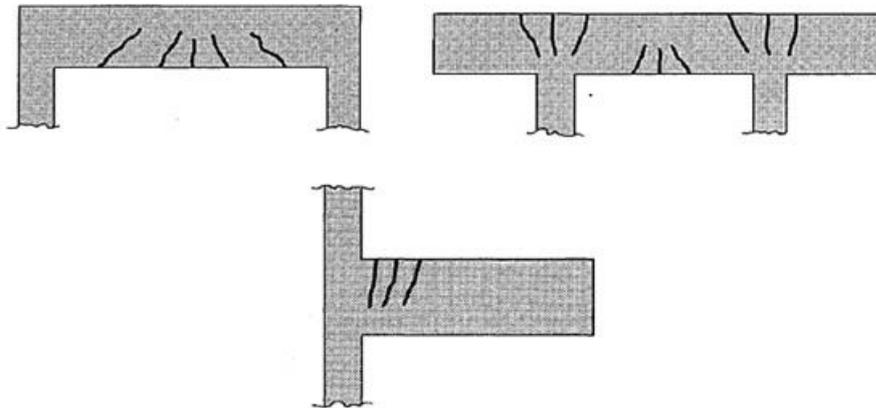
OTROS TIPOS DE FISURAS POR MOMENTO FLECTOR
